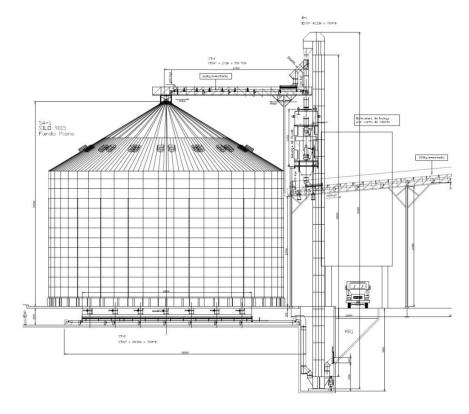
Instalações principais no lote 04 do Terminal de Porto Franco.
